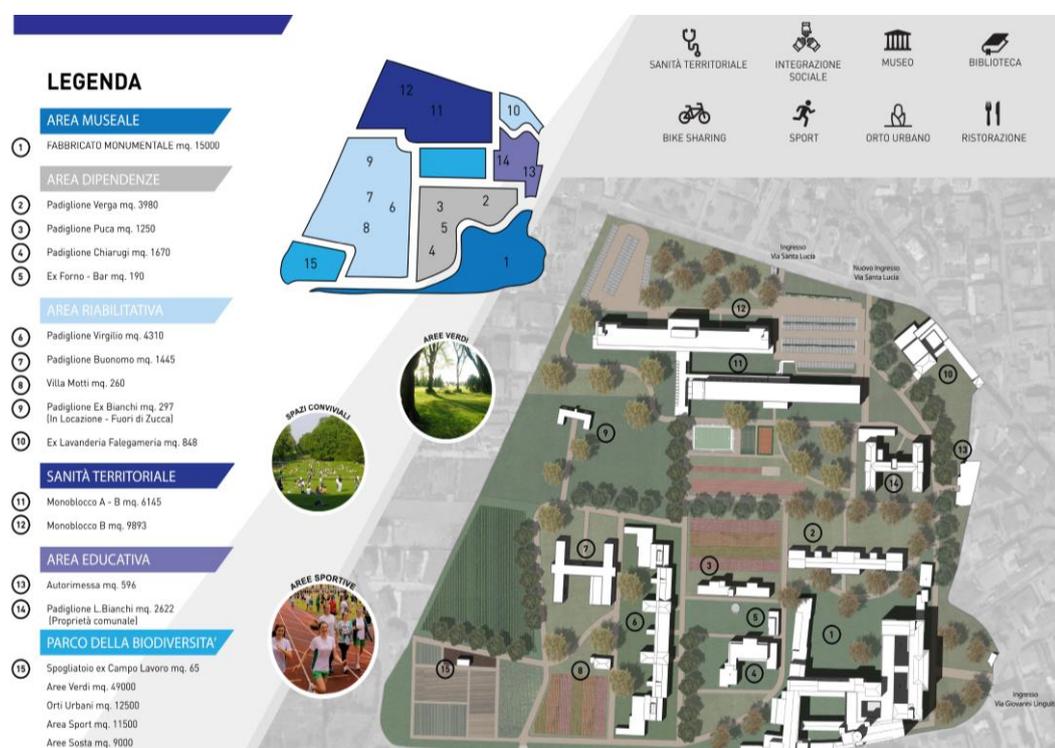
Planimetria di progetto dell'area Ex Ospedale Psichiatrico Santa Maria la Maddalena di Aversa.
